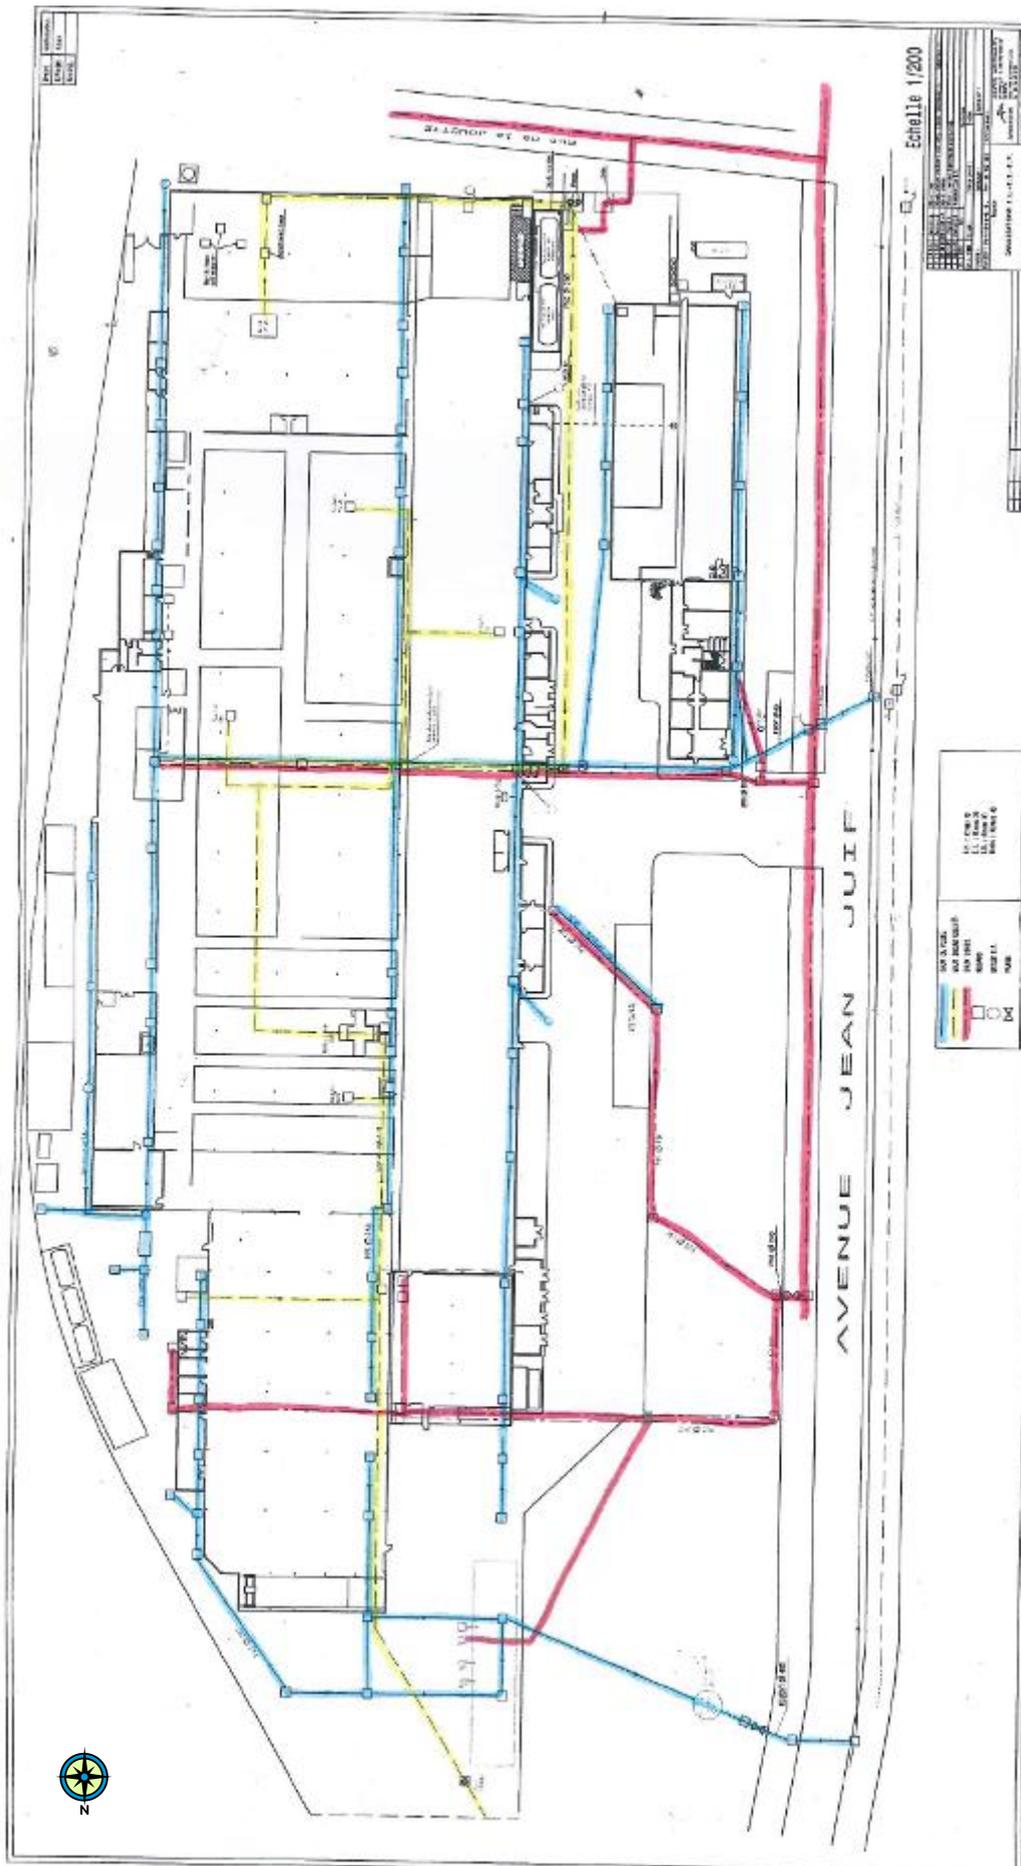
Plan de raccordement du site Arcelor Mittal.
